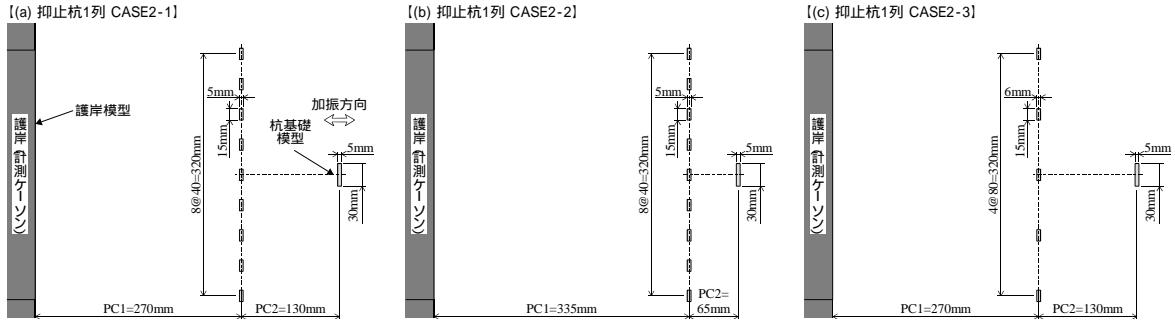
(a) 1G 中型振動台実験で実施した対策工の平面図
